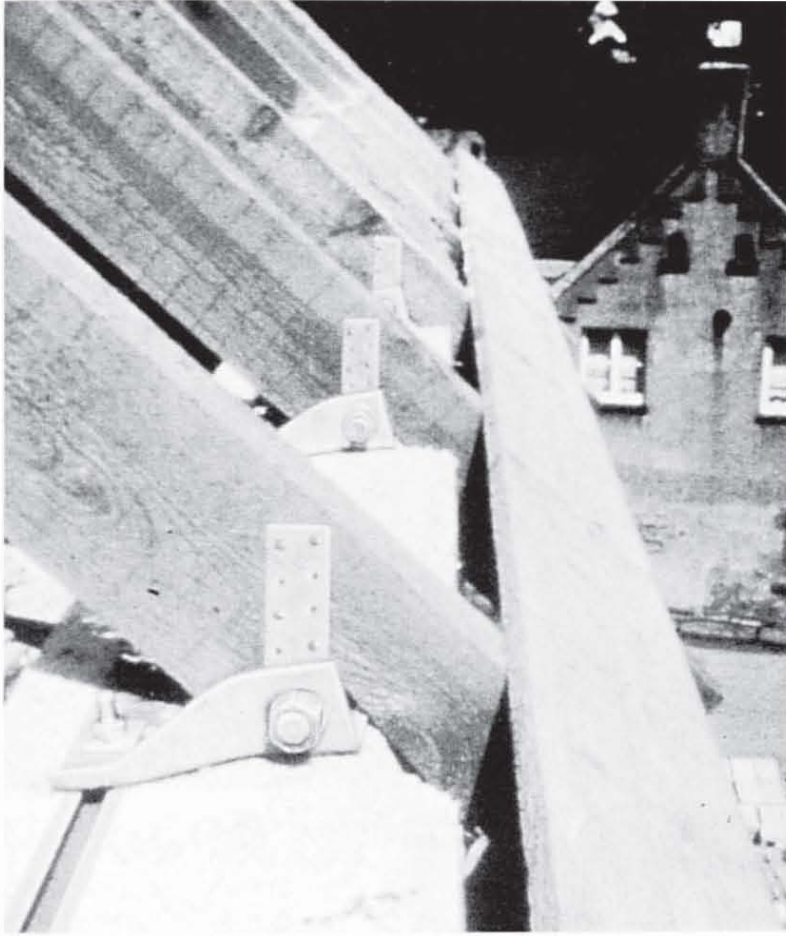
Anschluß eines Holzbinders an den Stahlbetonringbalken
